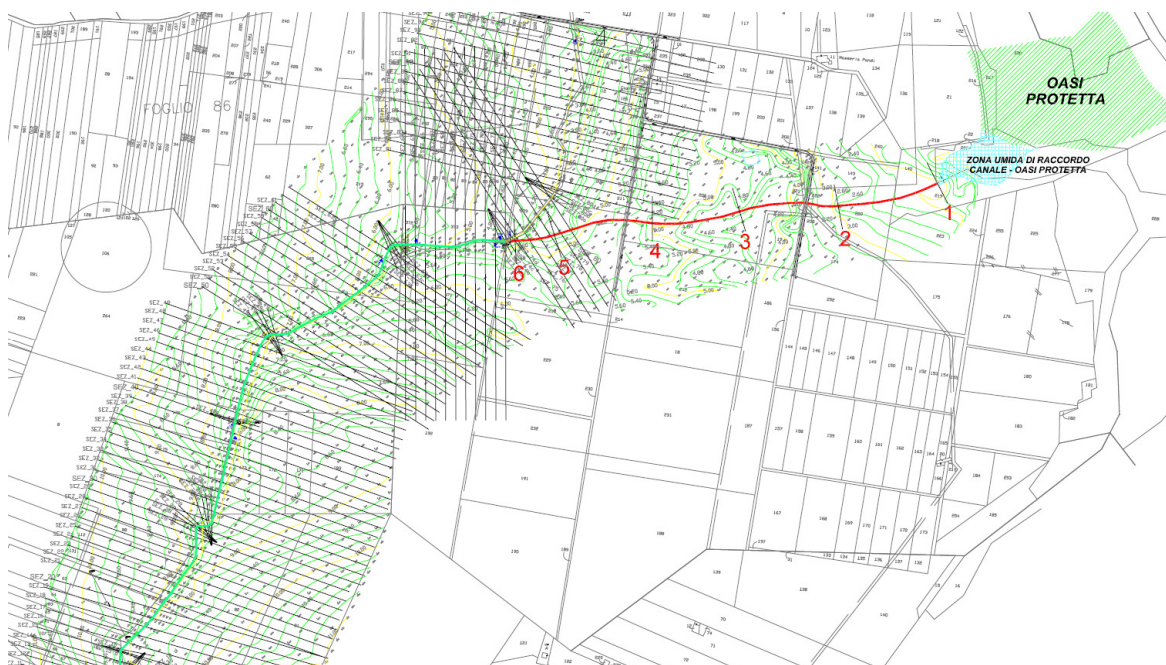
Tracciato del canale in progetto (in colore rosso) con sezioni
